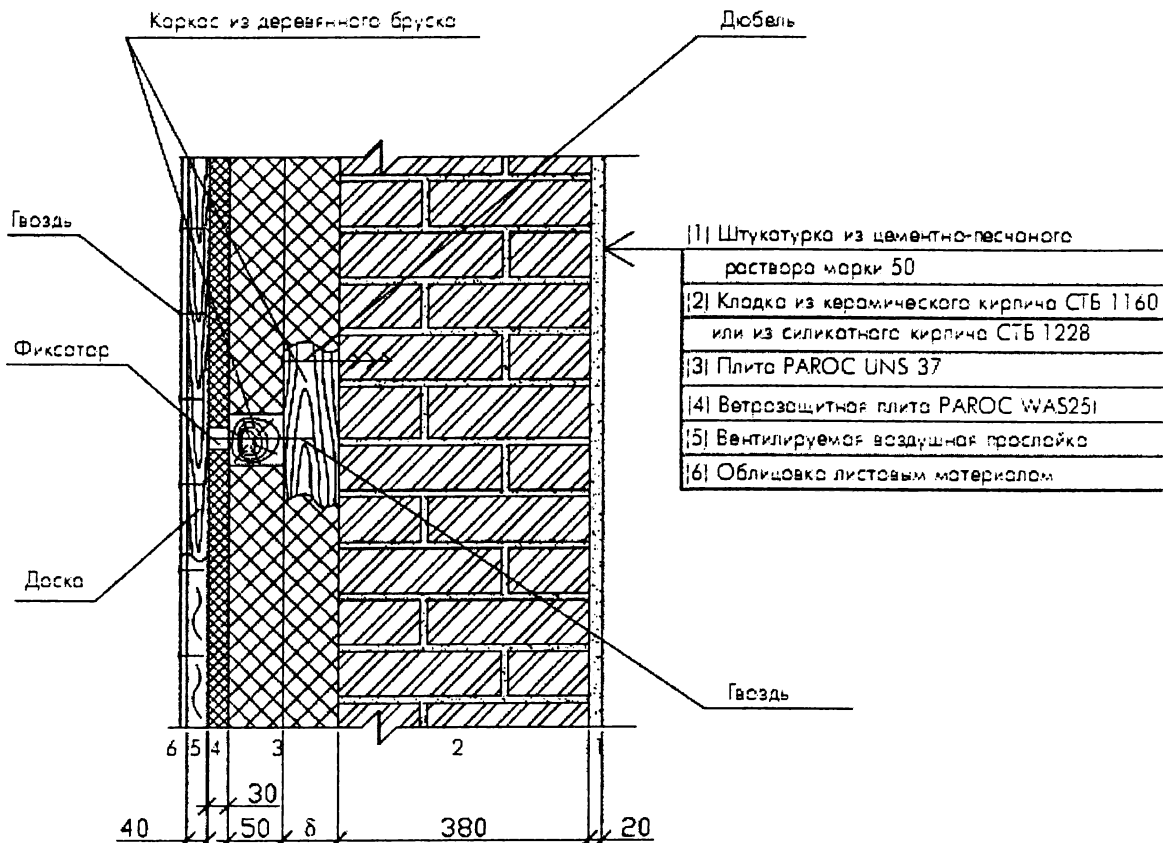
Несущая трехслойная кирпичная стена с утеплением по деревянному каркасу и вентиляруемой прослойкой, толщина внутреннего слоя 380 мм
